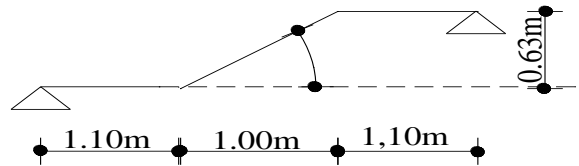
Schéma statique de la poutre brisée de l'escalier type 3.
